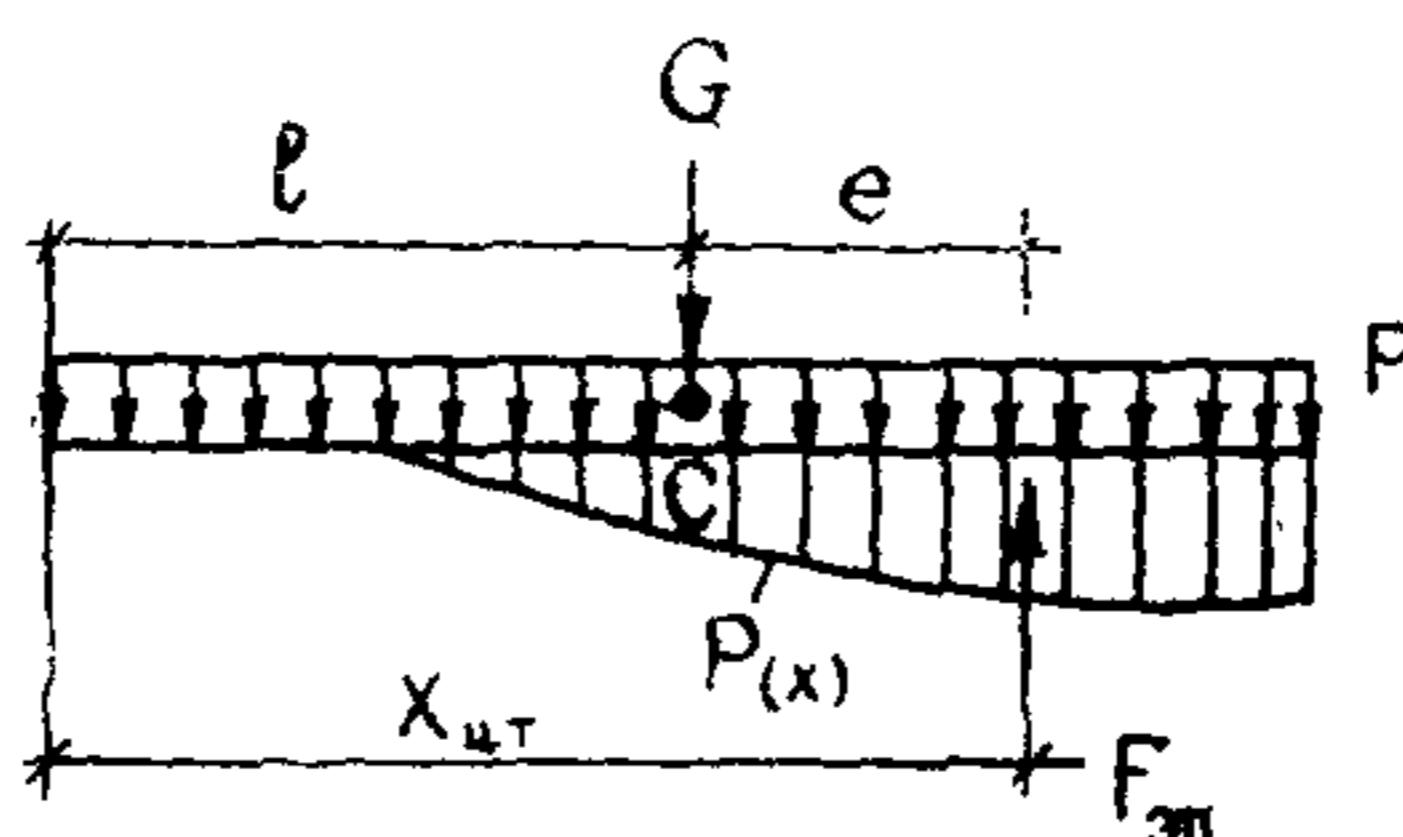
Расчетная схема отсека и вид эпюры реактивного отпора грунта.
